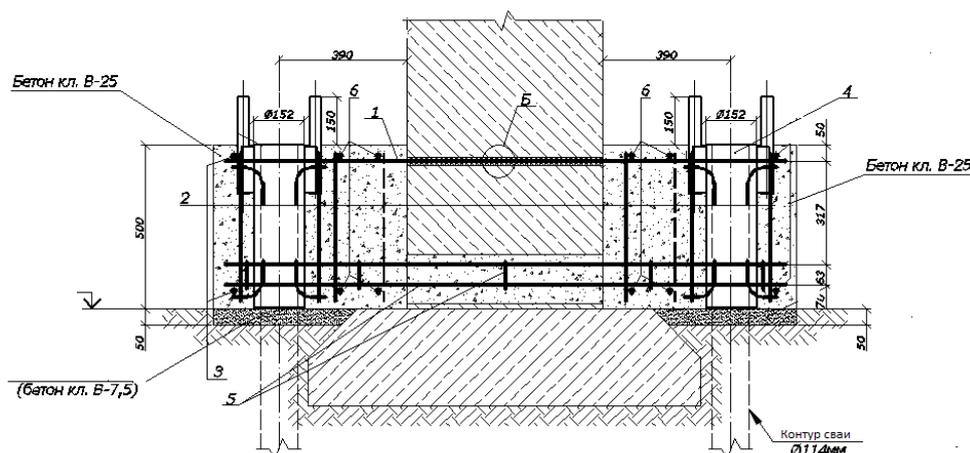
Устройство свай с поверхности железобетонных ростверков по двум сторонам существующего фундамента, соединенных между собой железобетонными балками
